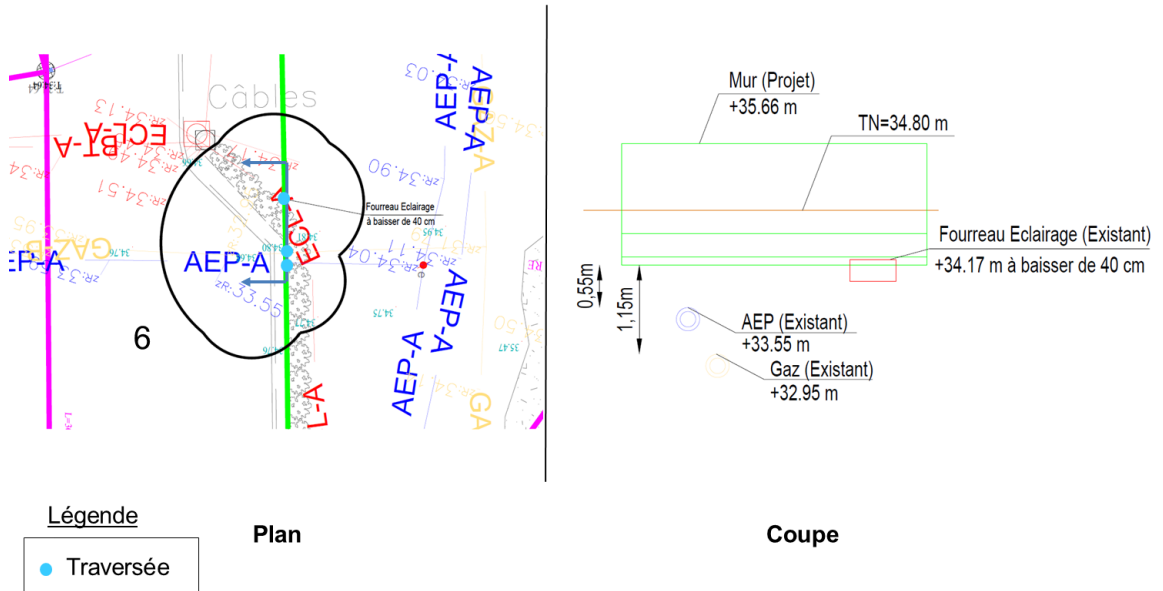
Mur traversant une conduite AEP, une conduite de gaz et un fourreau d'éclairage
